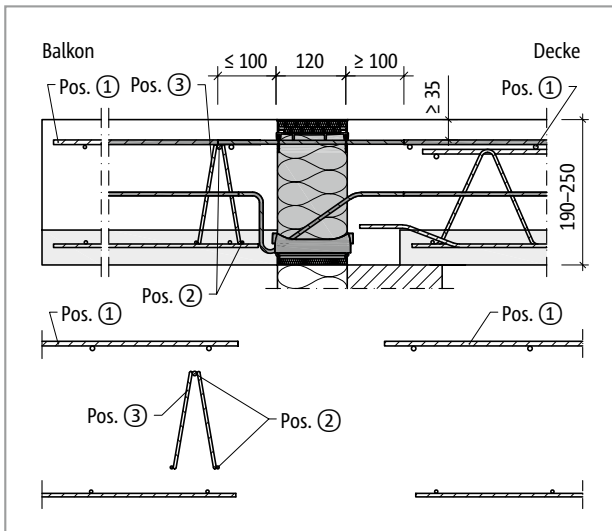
Schöck Isokorb® XT Typ K-F: Bauseitige Bewehrung bei Balkonplattendicke  $h = 190\text{--}250\text{ mm}$  mit Gitterträger (Pos.2:  $2\varnothing 8$ )
